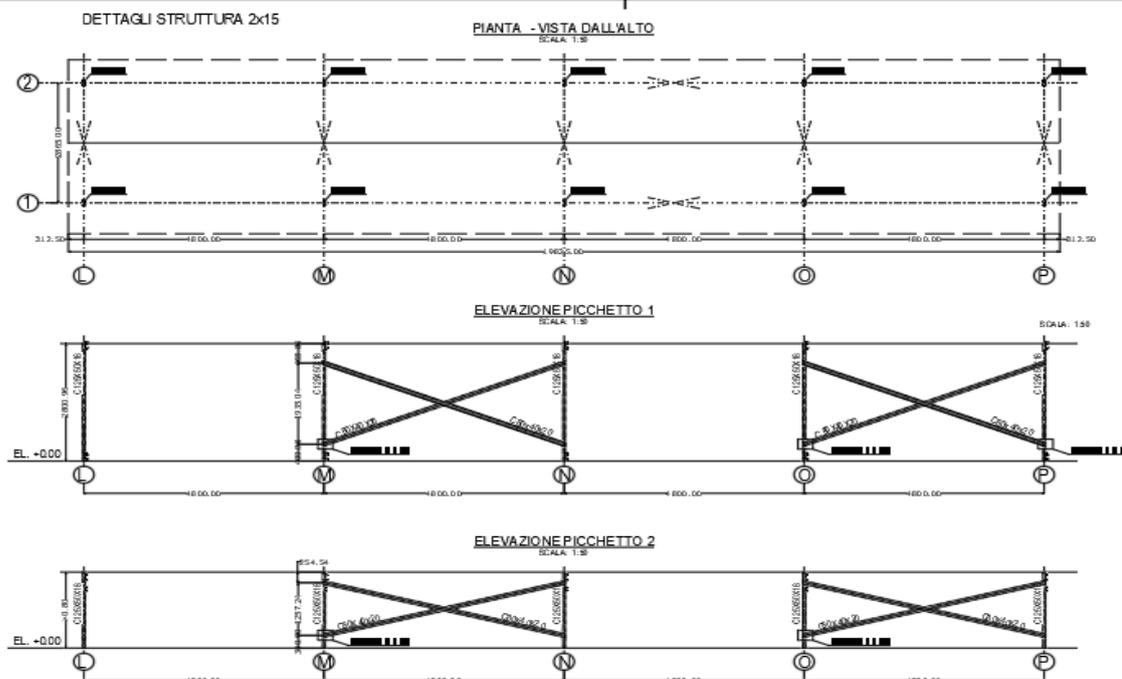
Configurazione Struttura portamoduli 2x15 (viste dall'alto e sezioni longitudinali)
